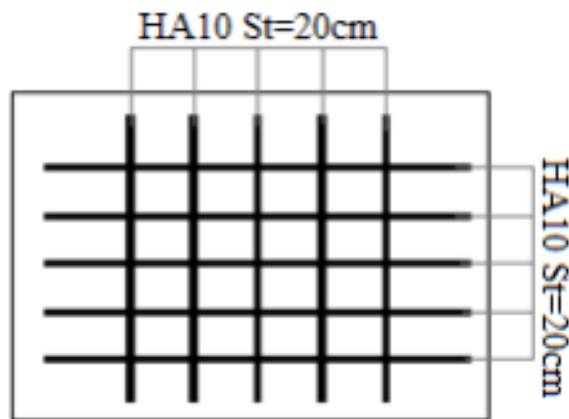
schéma de ferrailage de la dalle de l'ascenseur
